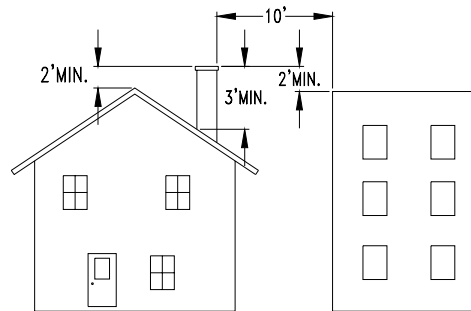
Dégagements minimaux de la cheminée par rapport au toit.
